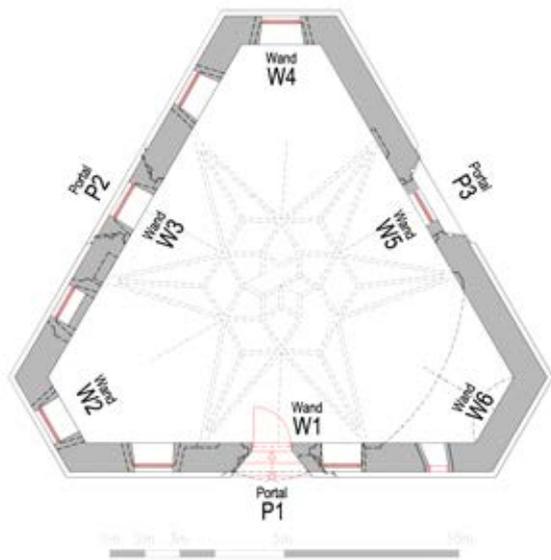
Erdgeschoßgrundriss mit Einzeichnung der Gewölberippen und Benennung der Wandfelder des Innenraumes. Zustand vor Restaurierung. © Zechner Denkmal Consulting GmbH
